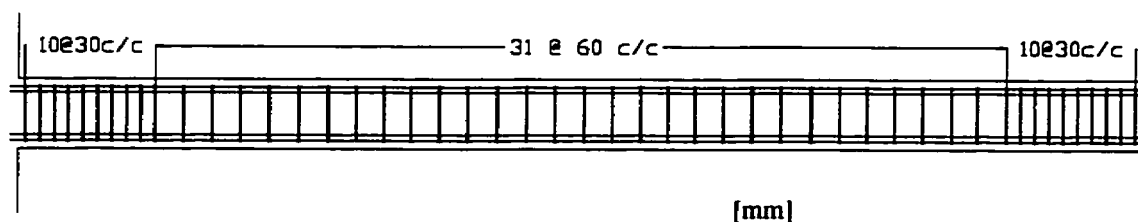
Disposition de l'armature transversale dans les poutres au toit.
